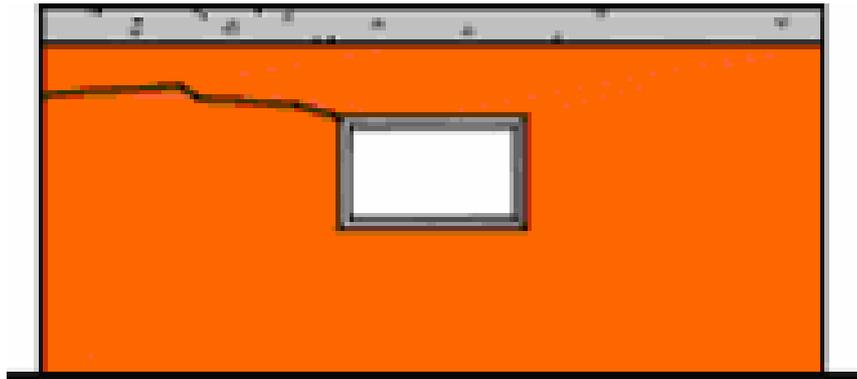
Fissuras em alvenaria externa, causadas pela retração de lajes de concreto.
